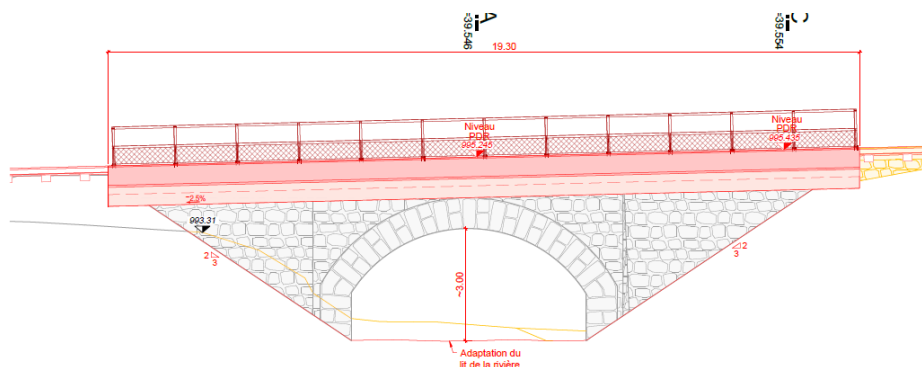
Elévation aval du pont de la Combabelle- extrait de plan
